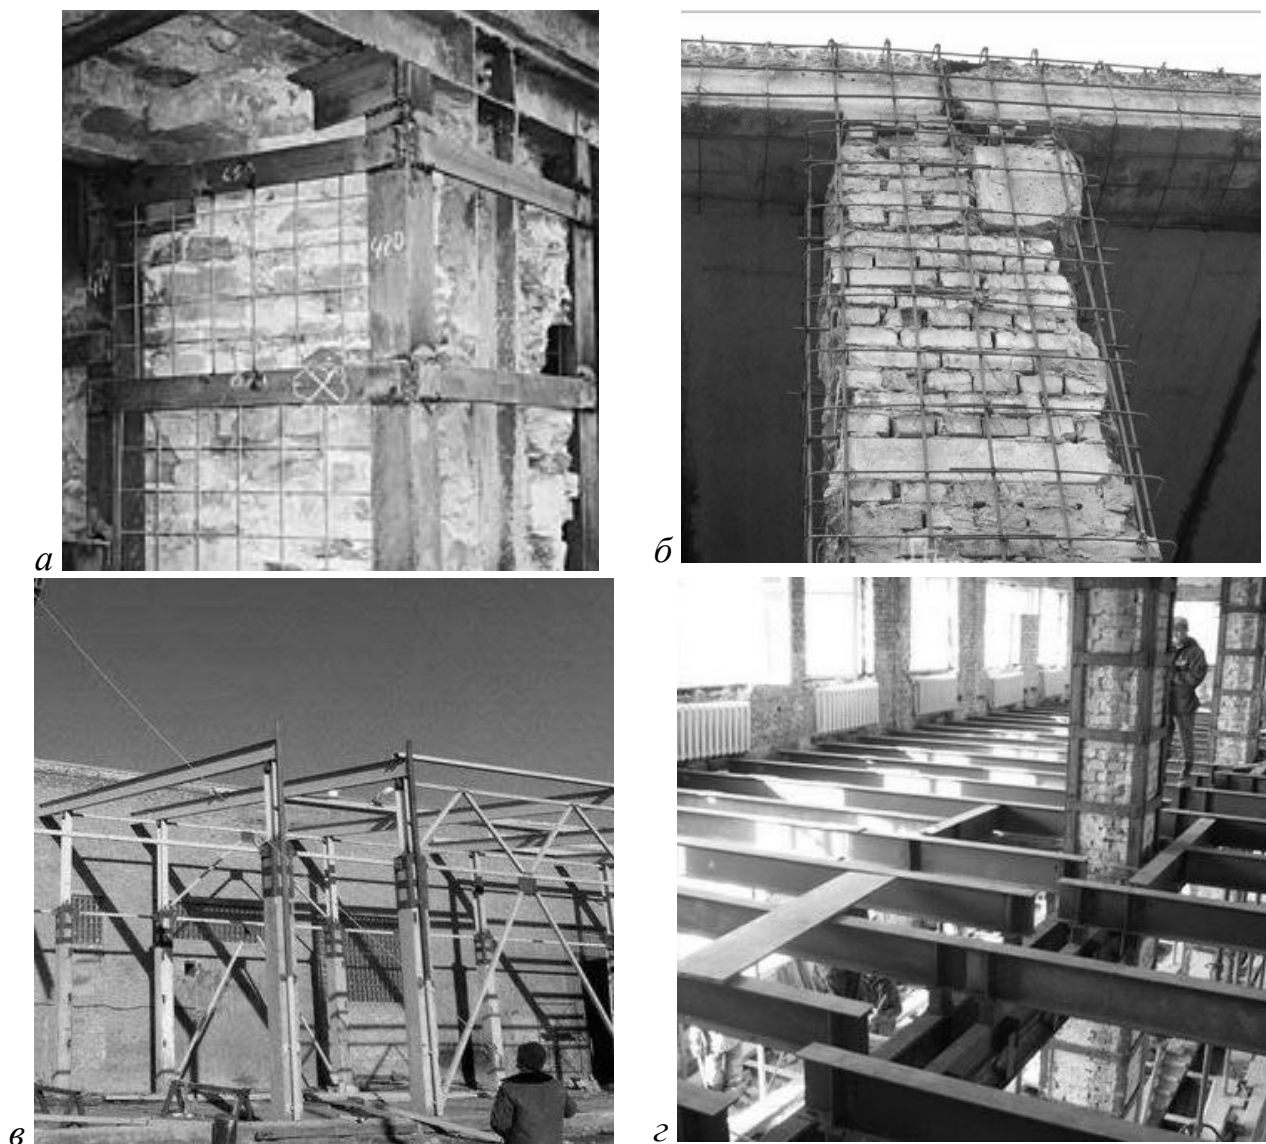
Конструктивная система здания в процессе пространственных преобразований: *а* – укрепление колонны с устройством железобетонной обоймы; *б* – наращивание как способ усиления конструкции; *в* – пристройка с использованием железобетонного каркаса, металлических диафрагм жесткости и металлических балок; *г* – замена перекрытия промышленного здания
